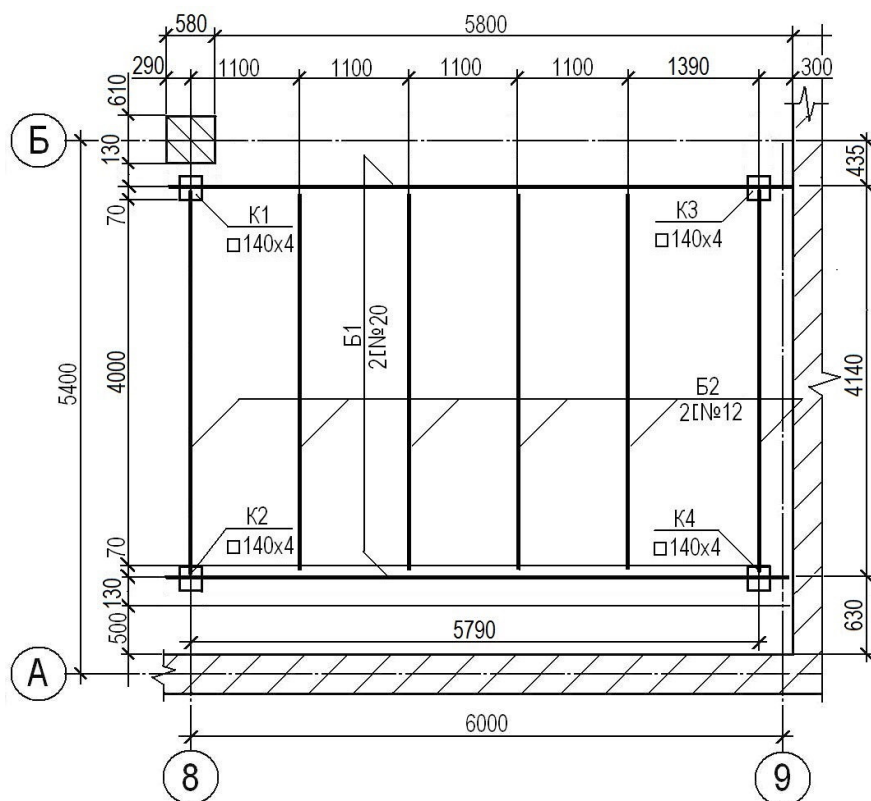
Фрагмент плану будинку з вказівкою елементів посилення
